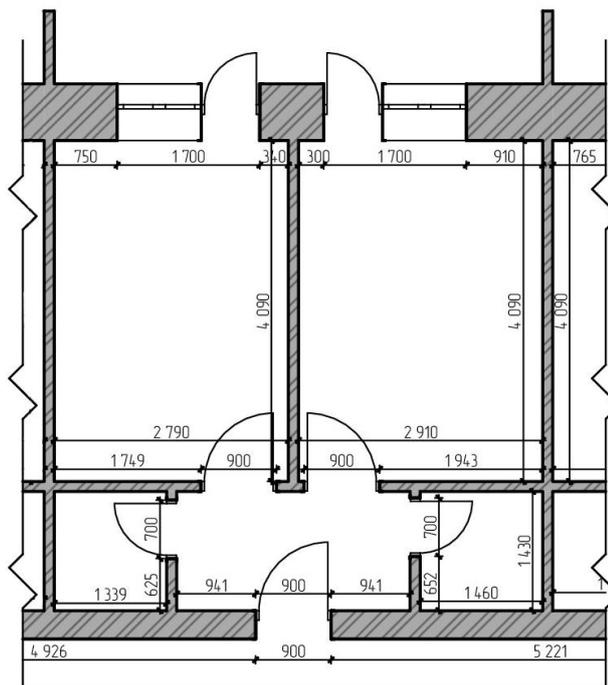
План спальни на 6 чел. до перепланировки
